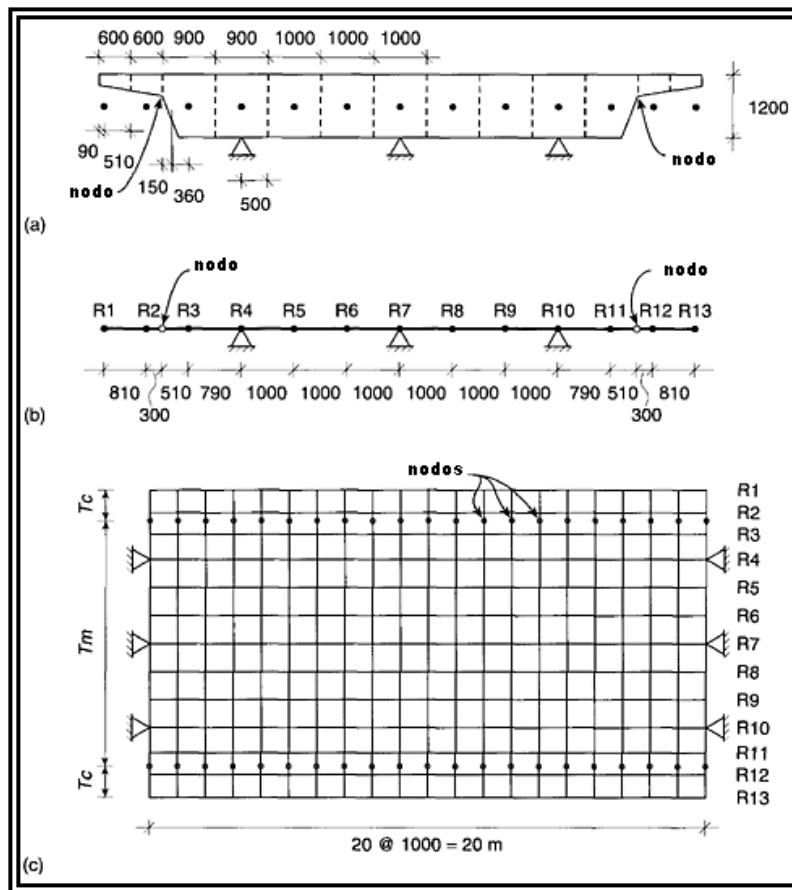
163 Modelo de grilla de puente con voladizo: (a) Sección transversal con segmentos respectivos, (b) Sección transversal con espaciamientos entre elementos de la grilla, (c) Planta de la grilla¹⁷⁷.
